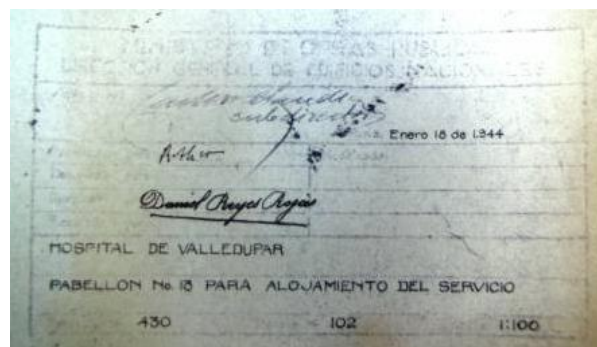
Ausschnitt des obigen Grundrisses, von Rother unterschrieben.
